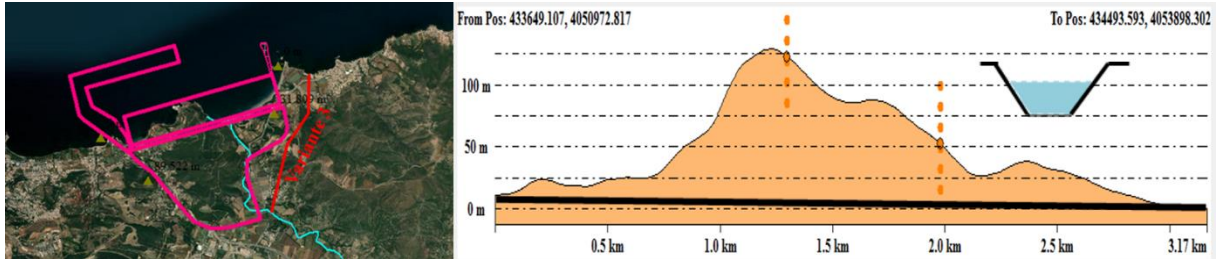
Vue en plan, profil en long et section en travers de la variante 3
